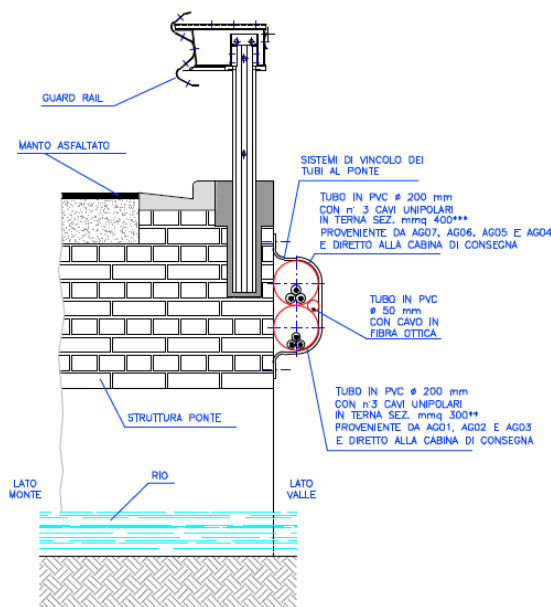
sezione tipologica di attraversamento su spalletta
